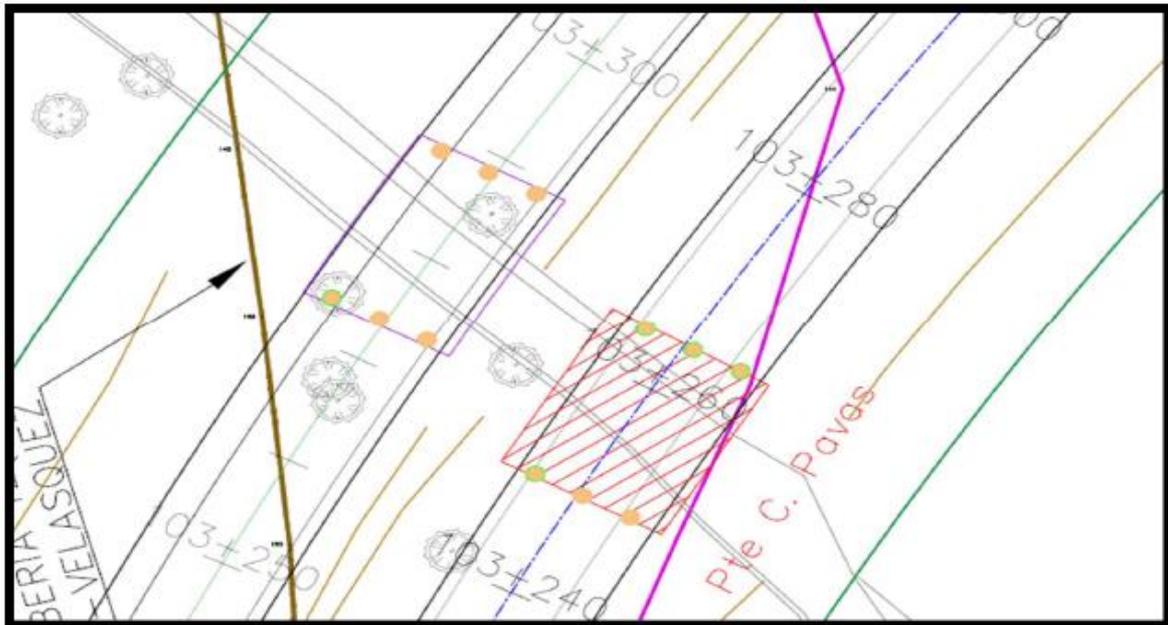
acercamientos críticos con estructuras viales (Puentes) e infraestructura petrolera
